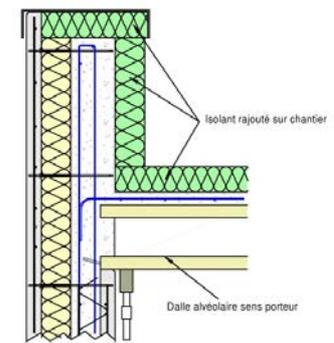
Dalle alvéolaire avec acrotère - Sens porteur
